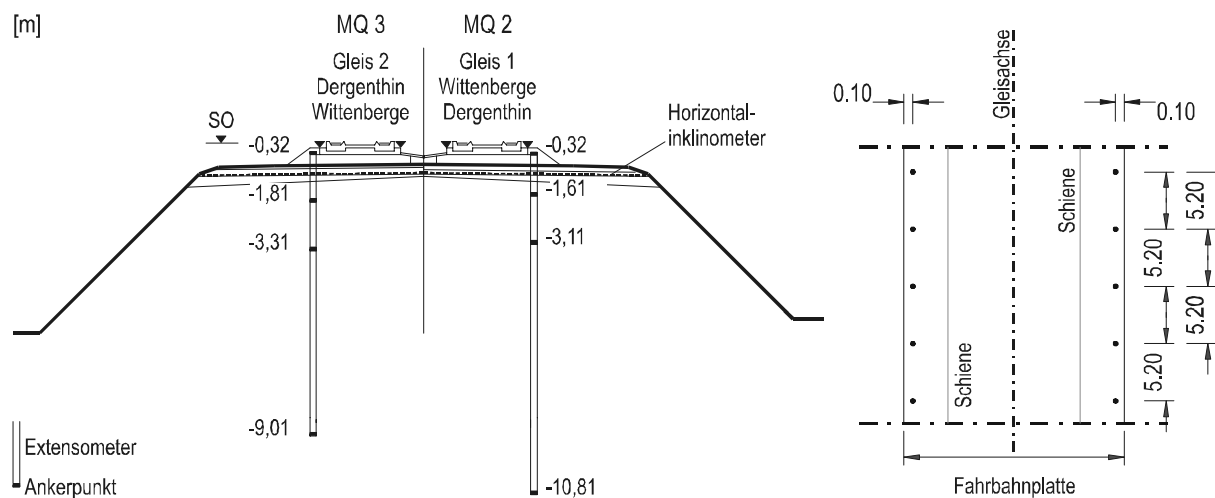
Querschnitt der Fahrbahnkonstruktion und Lageplan der Schottersäulen der durchgeführten Bodenverbesserung
